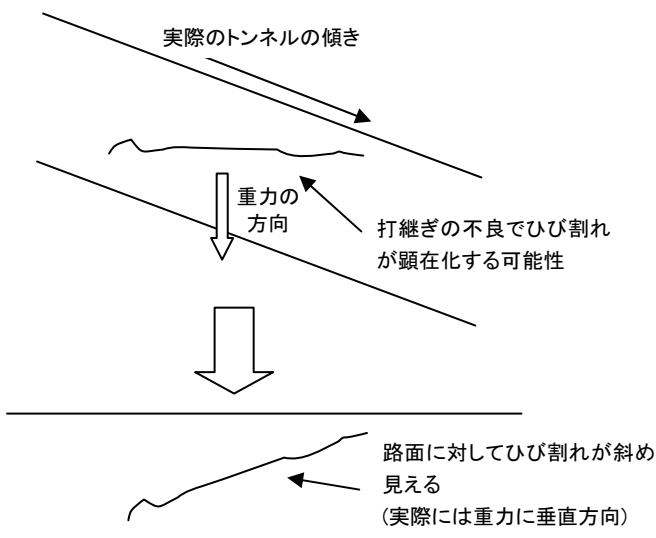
コールドジョイントによるひび割れの発生方向 (縦断方向: 斜めとなる場合)
